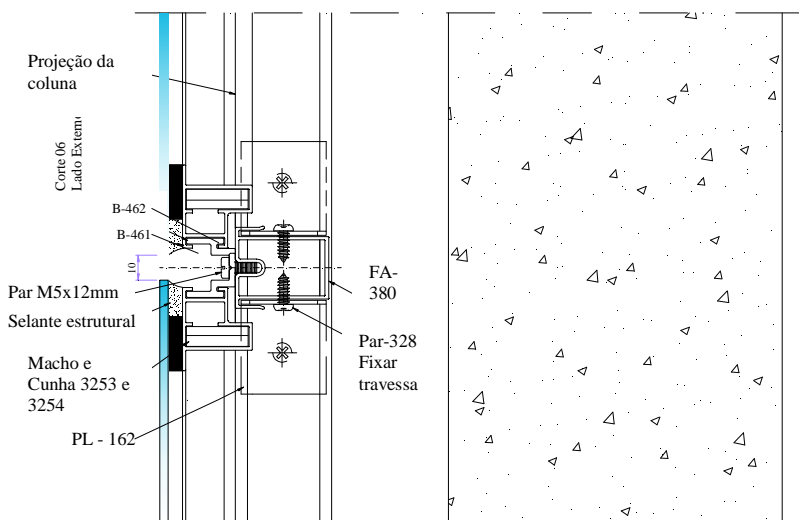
Corte 06: Corte vertical – junta intermediária. Cotas em mm.
